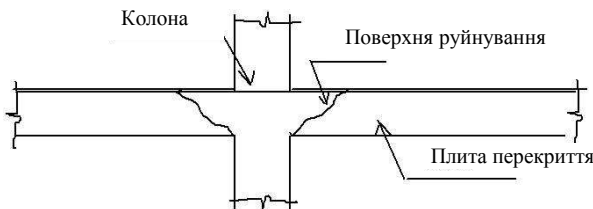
Схема для розрахунку залізобетонних елементів на продавлювання
